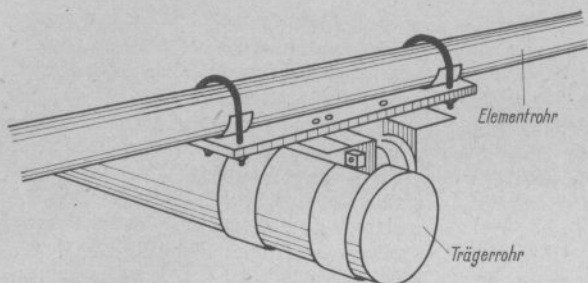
Konstruktionsvorschlag für eine Verbindungsarmatur
